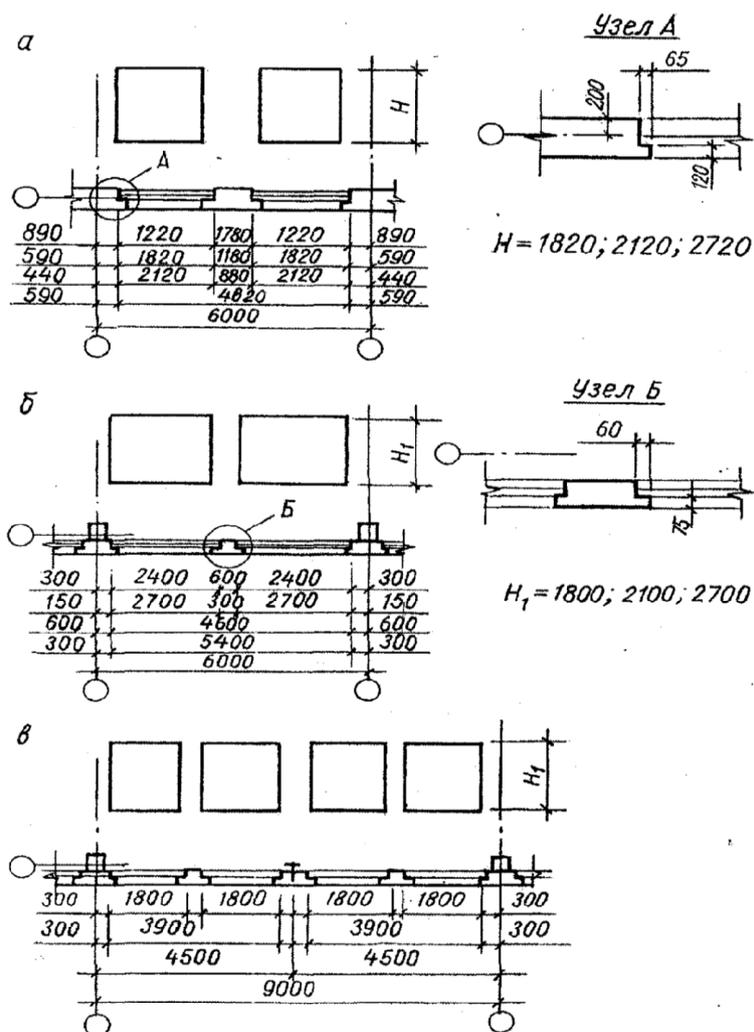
Разбивка оконных проемов: а - в кирпичных стенах; б, в - в панельных стенах
